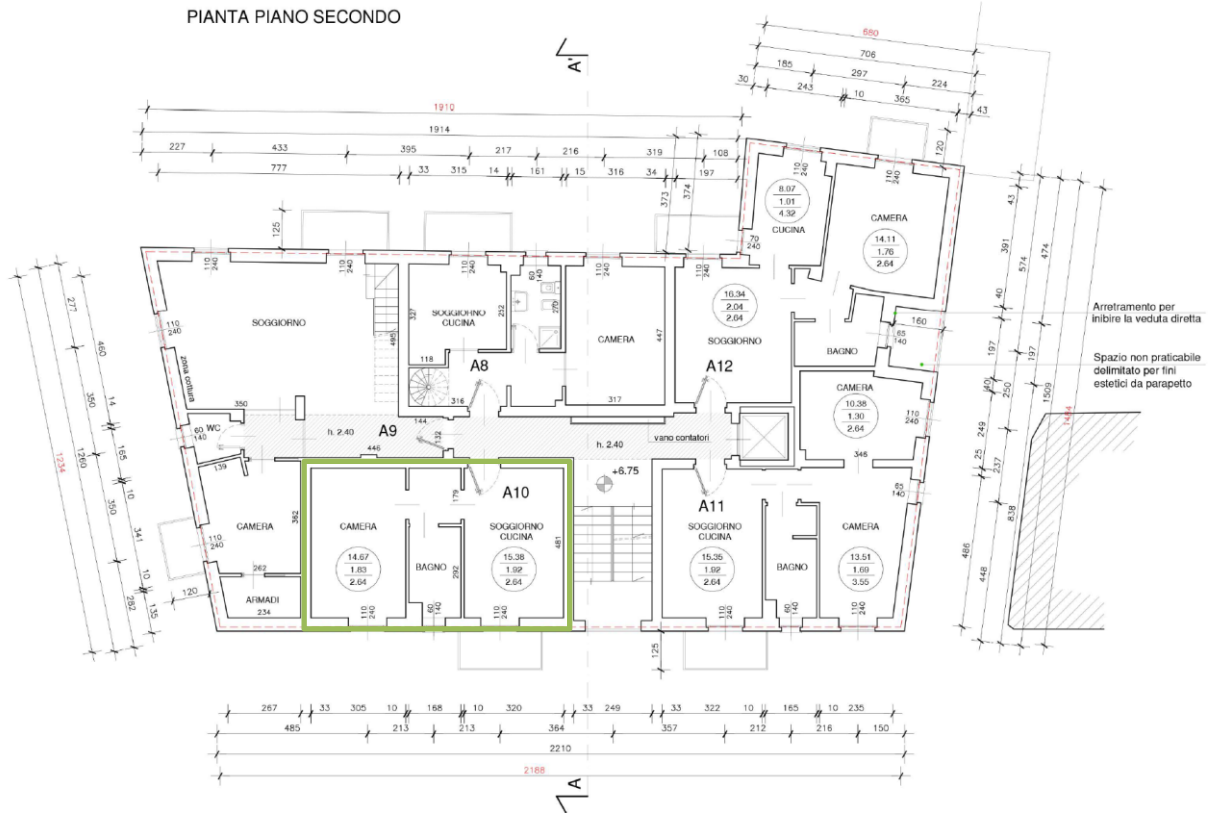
ESTRATTO PIANTE PIANO SECONDO SCIA N. 5709 DEL 2019
